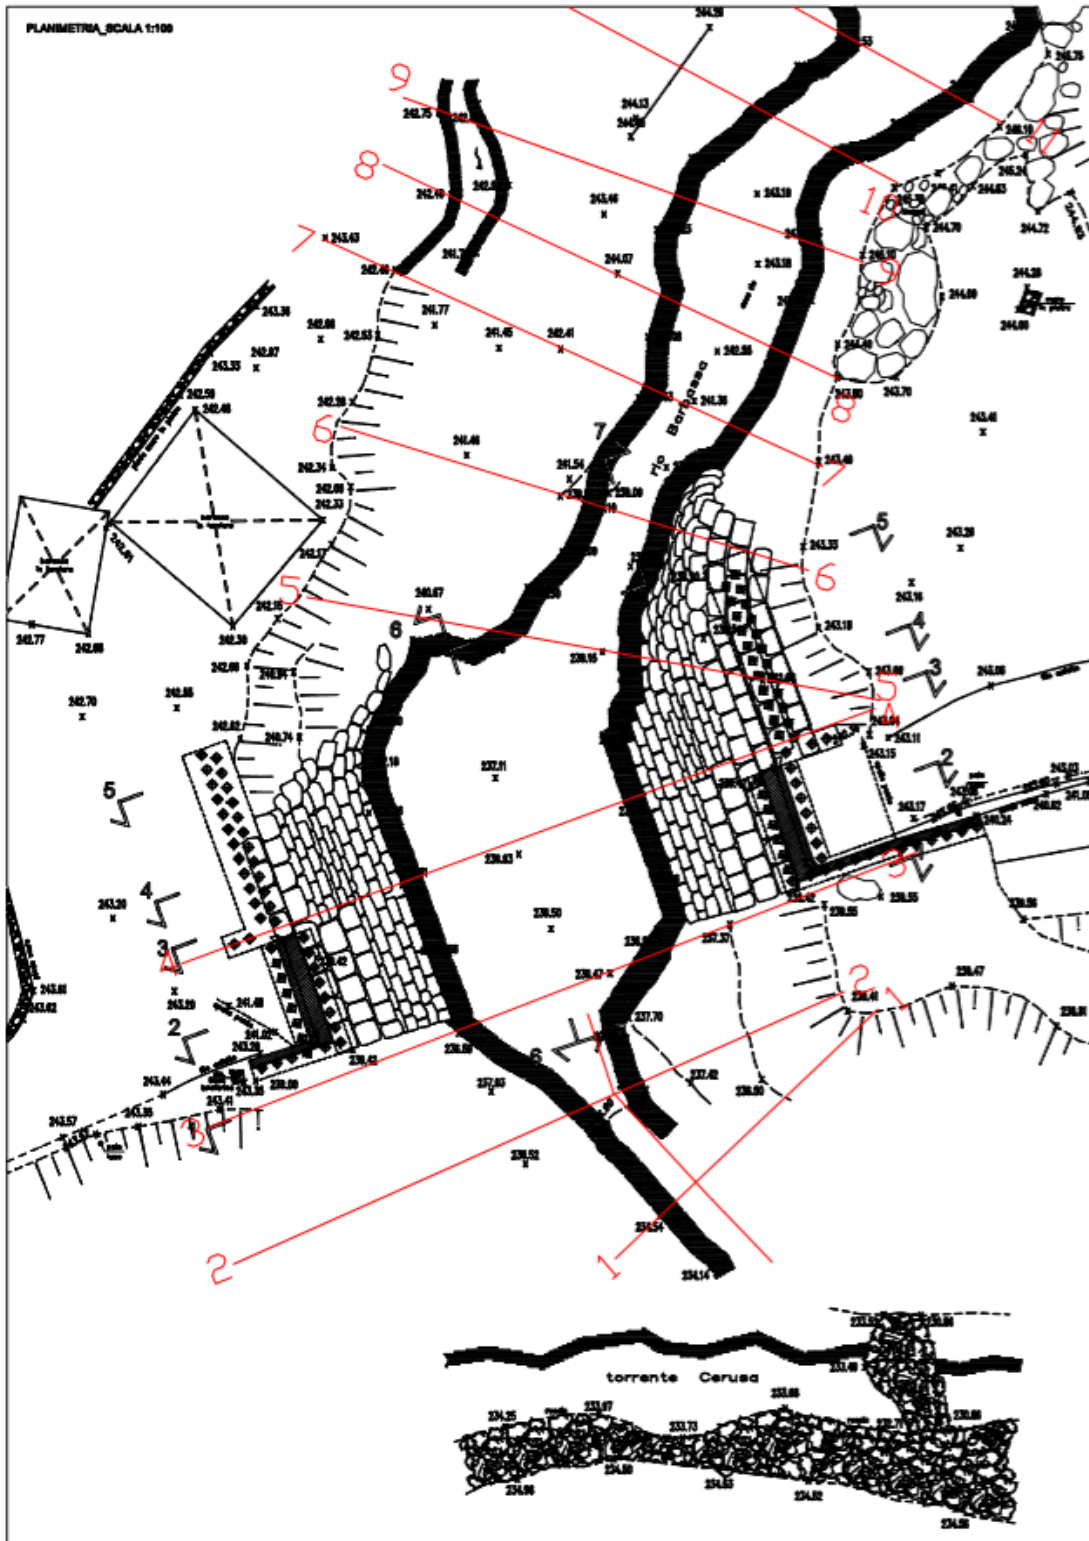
Planimetria stato di progetto con riferimento delle sezioni
